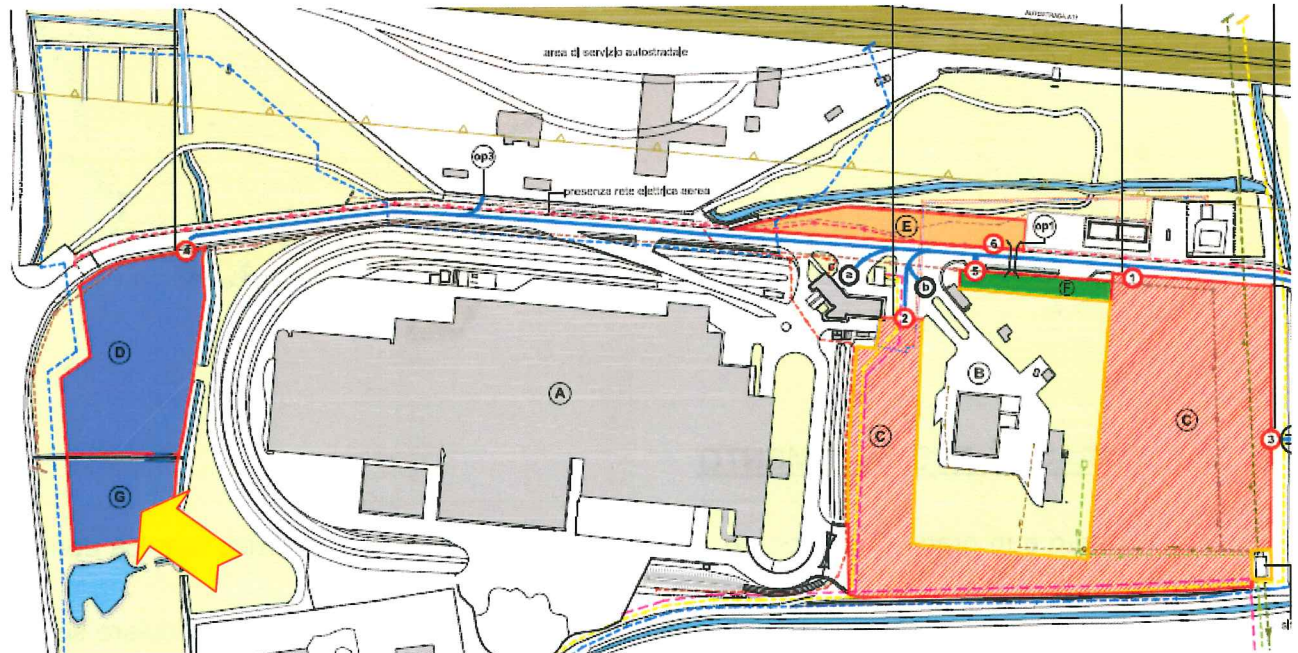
Aree di cantiere - Zona stoccaggio terre di scavo
